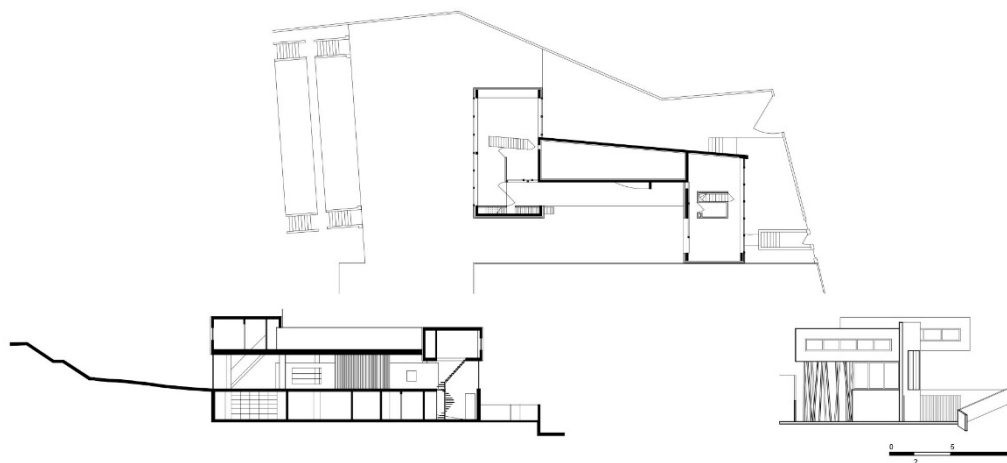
Redesenho da planta, corte e elevação – Villa dall'Ava
